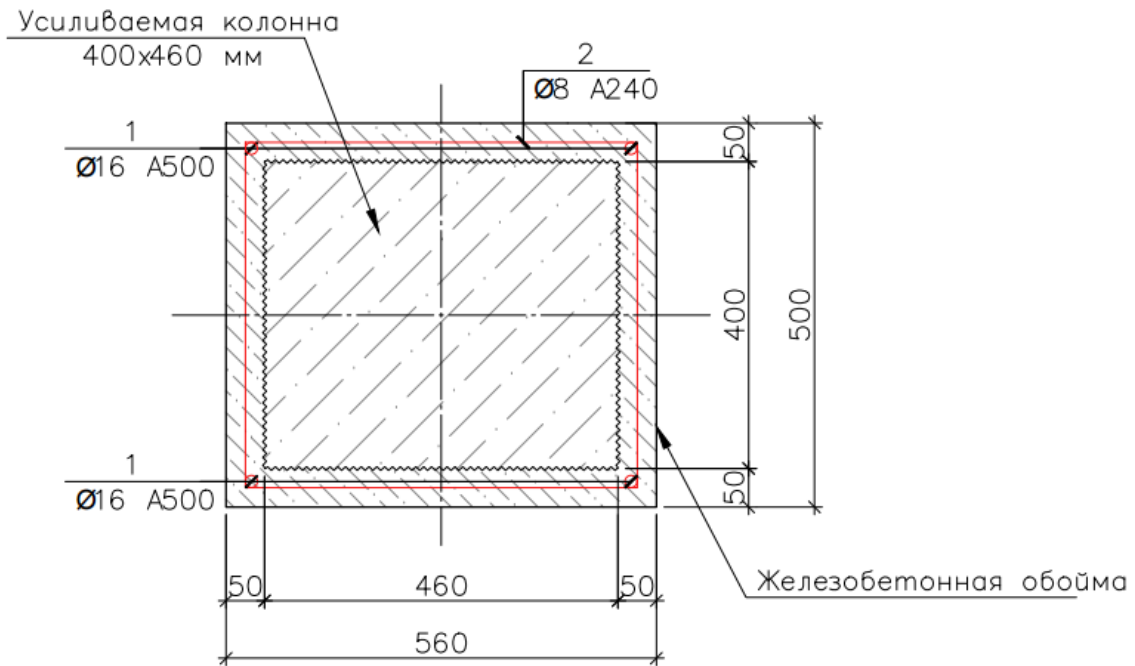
Схема усиления железобетонной обоймой разрез А-А
